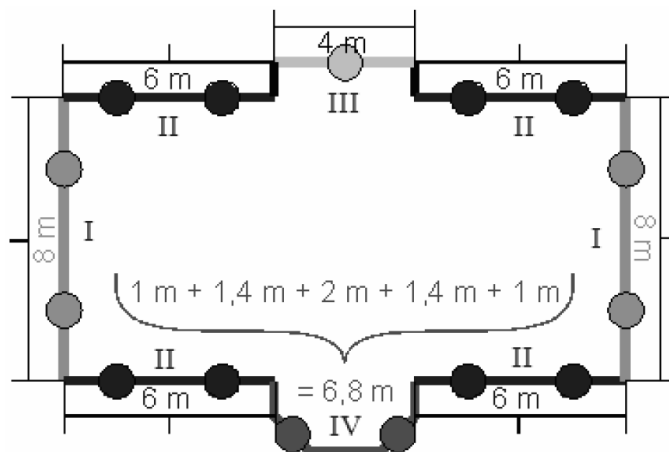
Beispiel zur Festlegung der Position der maßgeblichen Immissionspunkte anhand eines Gebäudegrundrisses/Dachaufsicht⁵
